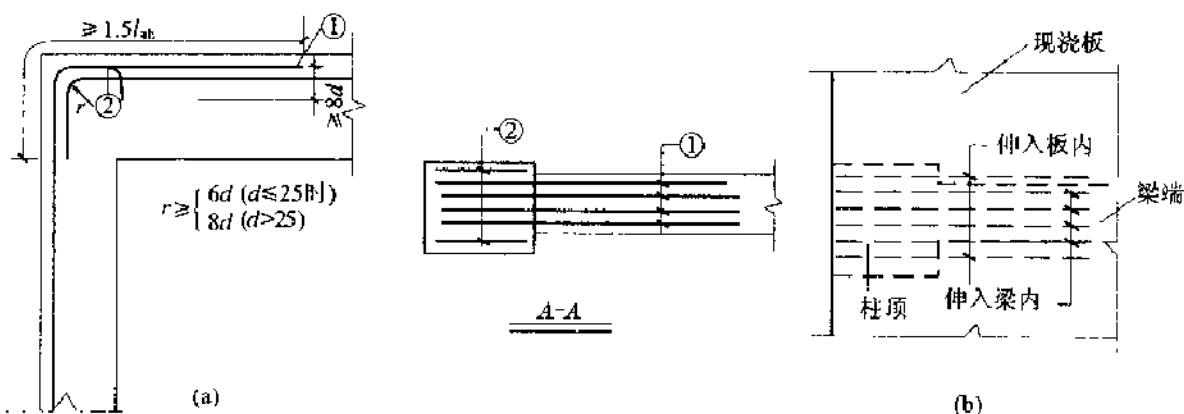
顶层端节点处纵向钢筋的梁内搭接
